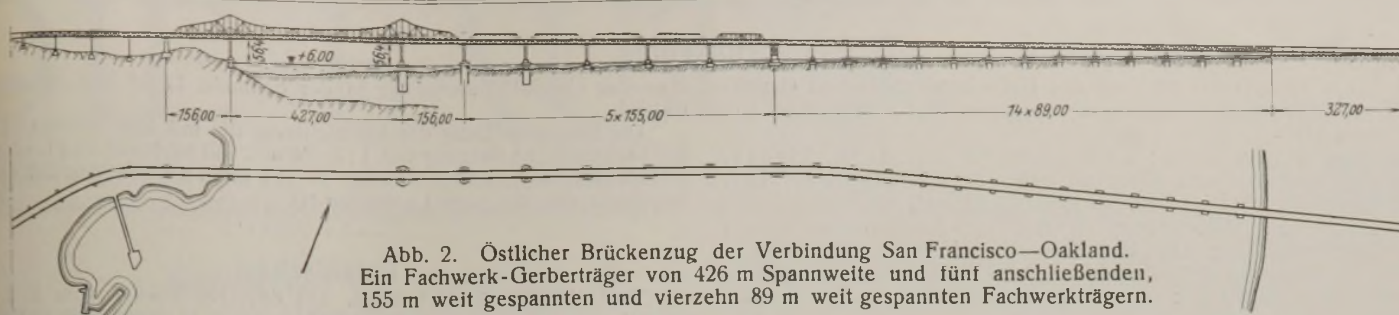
Östlicher Brückenzug der Verbindung San Francisco—Oakland. Ein Fachwerk-Gerberträger von 426 m Spannweite und fünf anschließenden, 155 m weit gespannten und vierzehn 89 m weit gespannten Fachwerkträgern.
